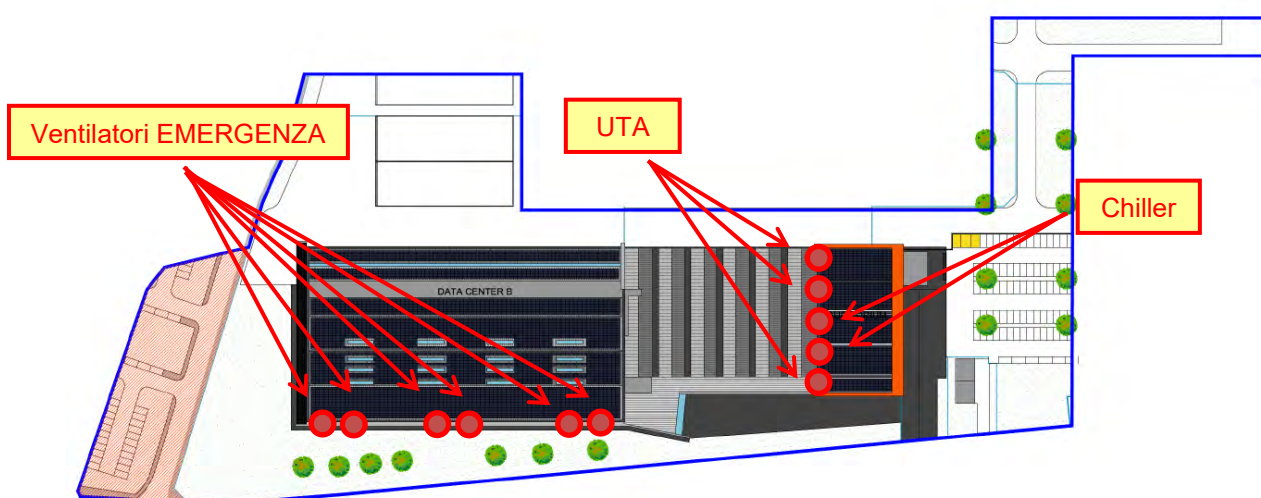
Stralcio planimetrico con individuazione delle sorgenti previste - UMI 2 stato modificato.
